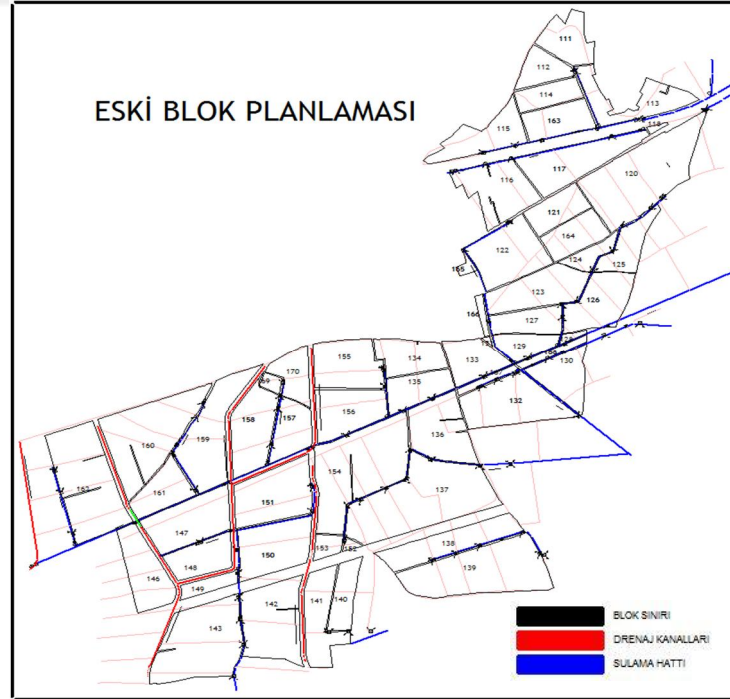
49. Hamidiye Mahallesi İçin Örnek Olarak Planlanan Blokların Şekil Durumu
